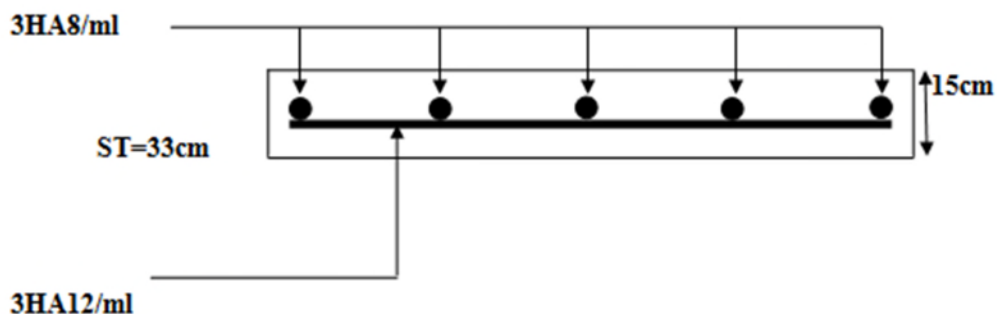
Schéma de ferrailage de la dalle pleine type N°1
